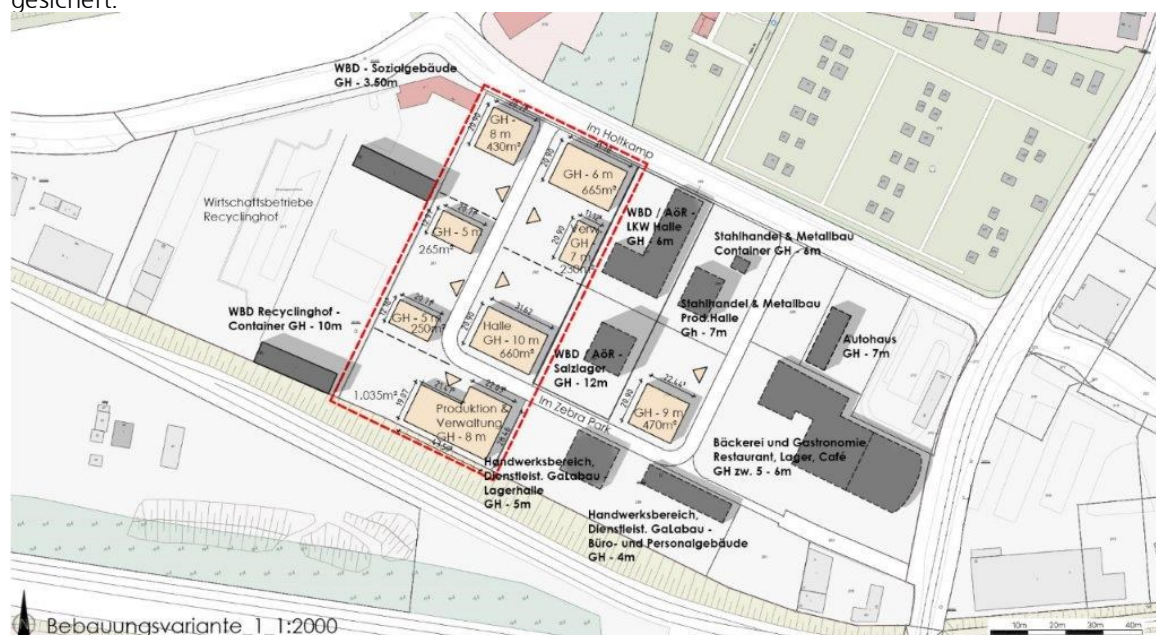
Bebauungsvariante 1, Städtebauliches Konzept der Teilaufhebung Nr. 1276 -Röttgersbach- „Im ZebraPark“, ohne Maßstab; Quelle: WBD, Gebag
